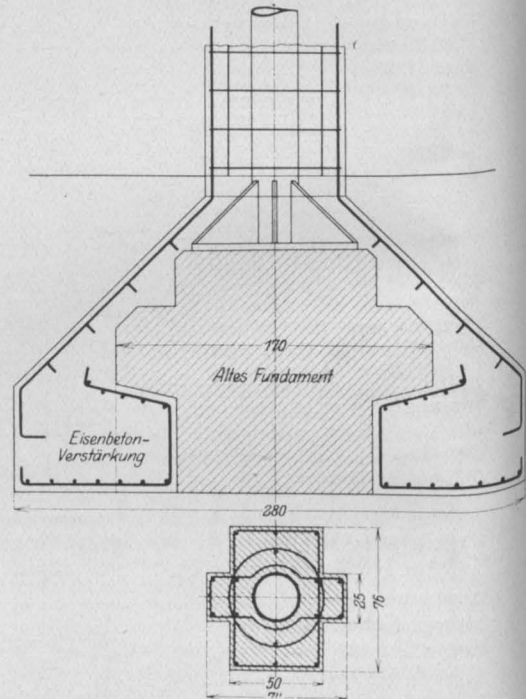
Eisenbeton-Verstärkung einer Gußeisensäule.
